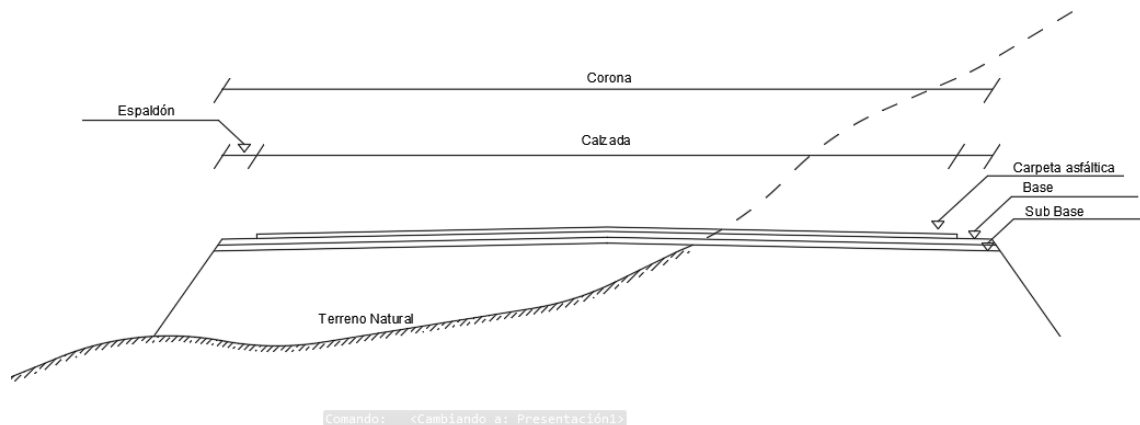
Sección transversal típica. [Castro & Fajardo, 2023]
